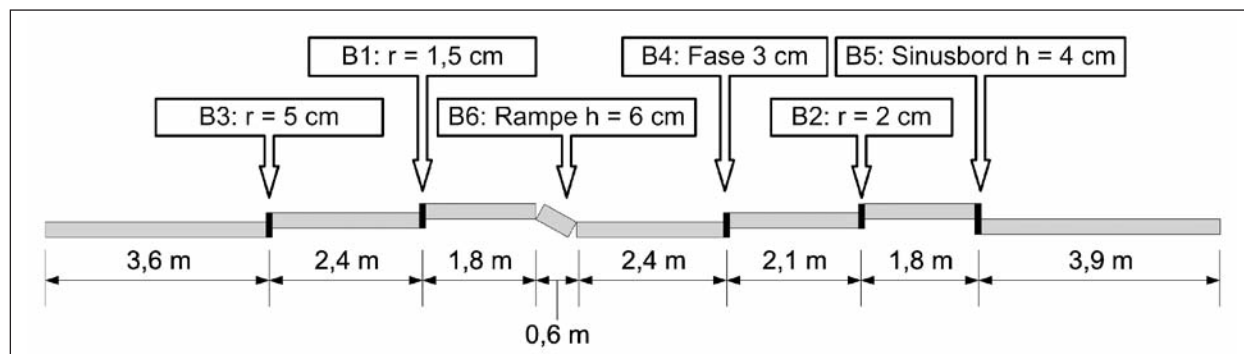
Teststrecke mit Bordsteinen – Ansicht im Höhenprofilaufbau der Teststrecke mit Bodenindikatoren
